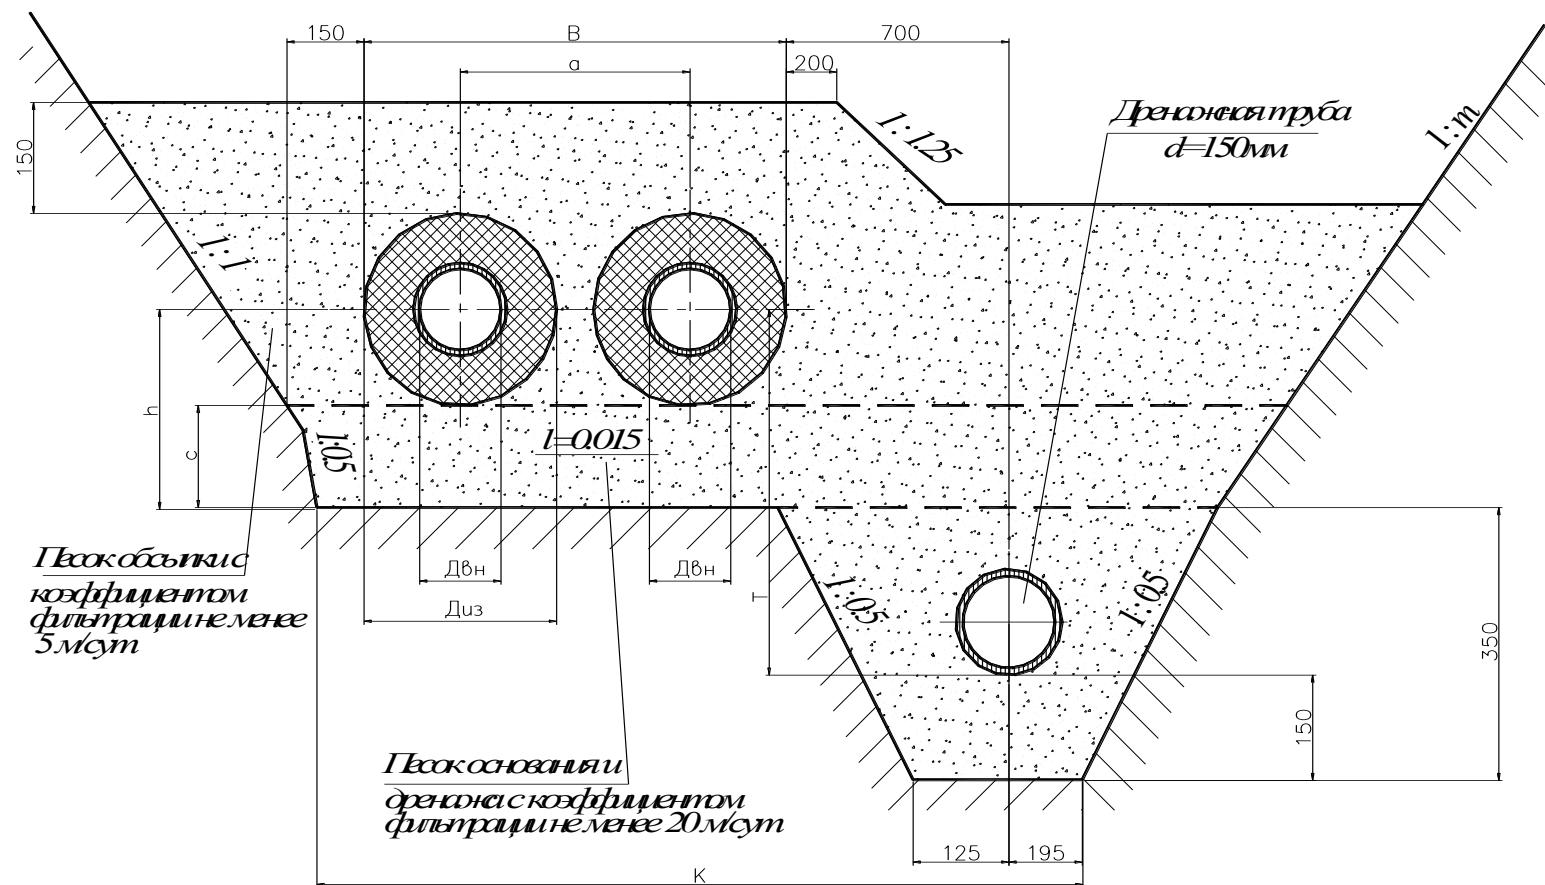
Бесканальная прокладка теплопроводов в ППМ изоляции в траншеях с откосами с устройством продольного дренажа.
